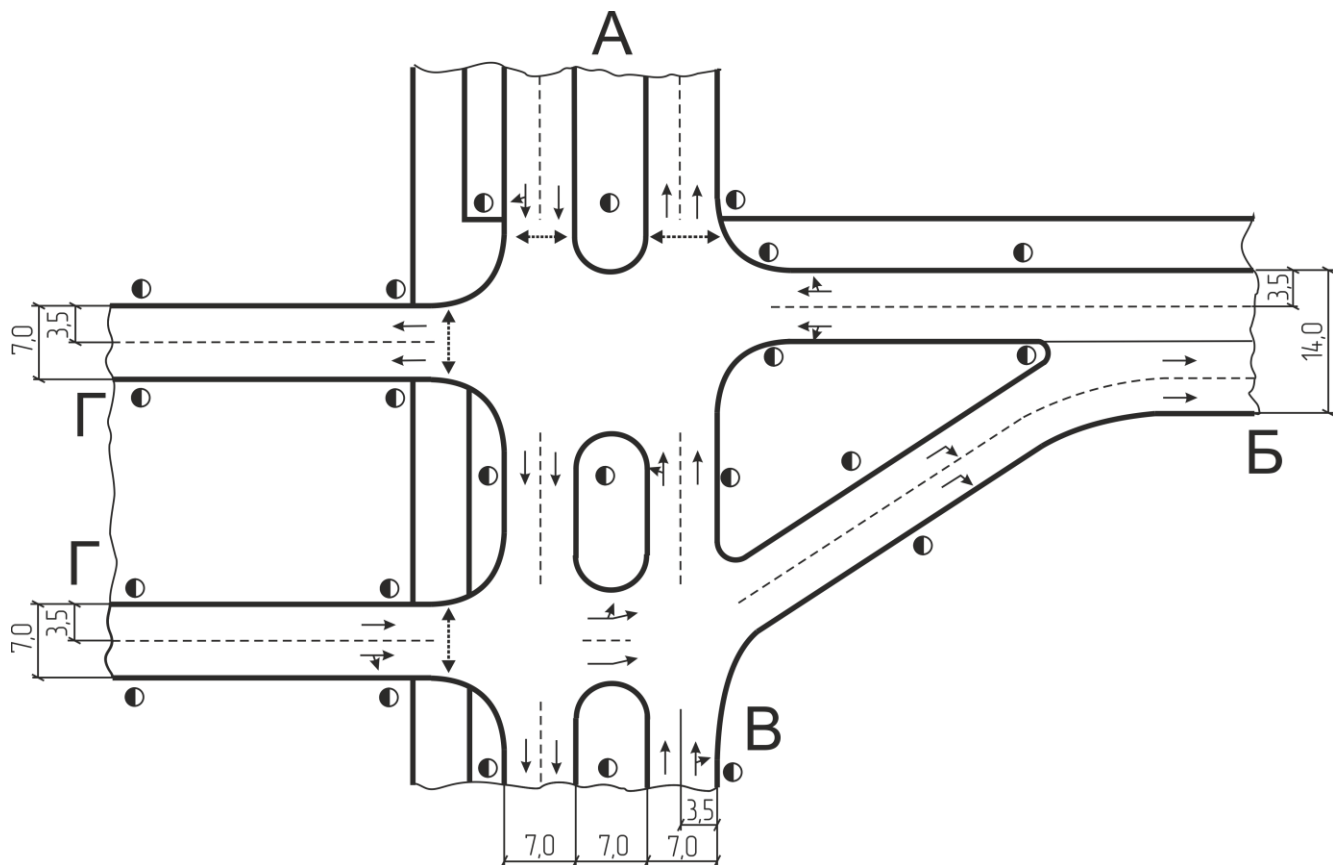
План перехрестя для розробки схеми ОДР за варіантами 17...24
